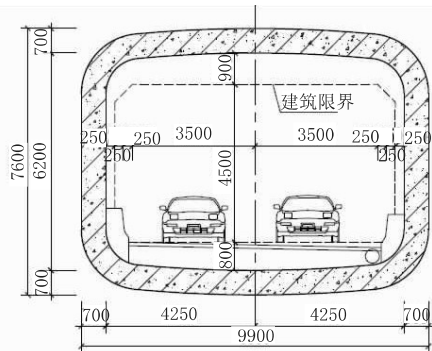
矩形盾构方案隧道结构横断面图(单位:mm)
